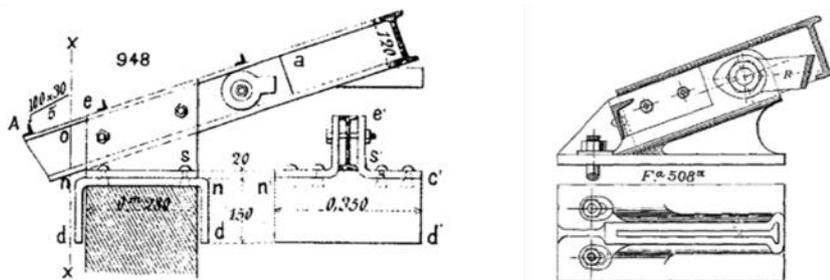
Detalles de piezas especiales para apoyo de cerchas articuladas sobre muro.
